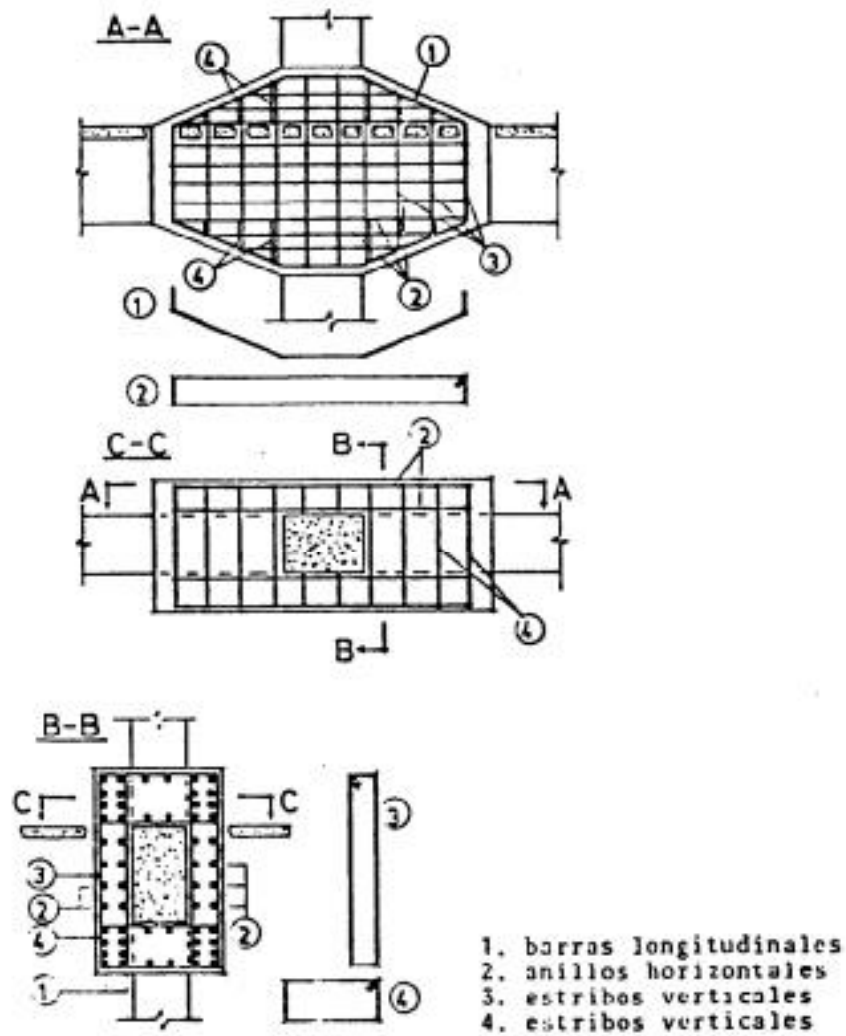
Encamisado local de un nudo con concreto reforzado (ref. 1)
